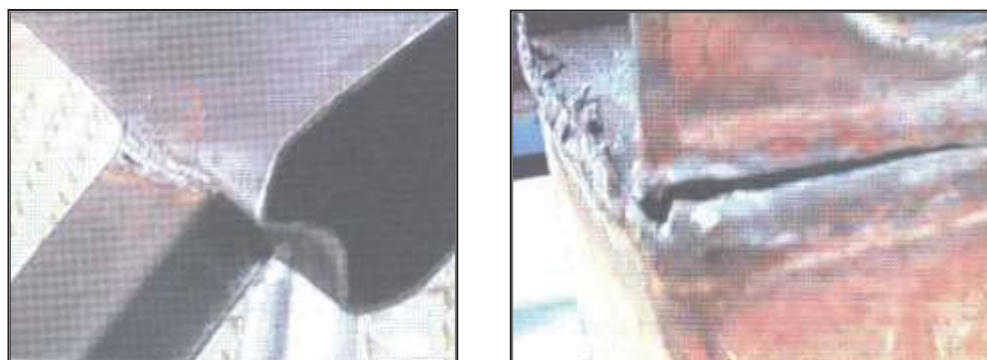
Fallas en ensayos de conexiones directas entre STT.
